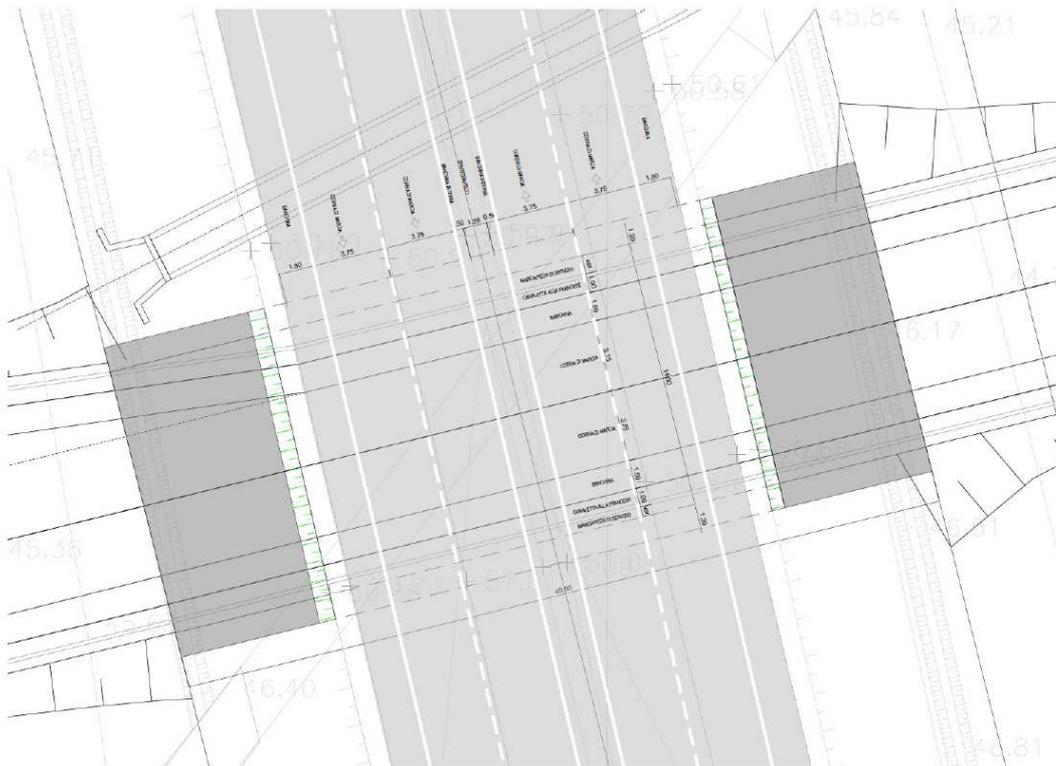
Sottovia A14 – Planimetria (Soluzione 1)
